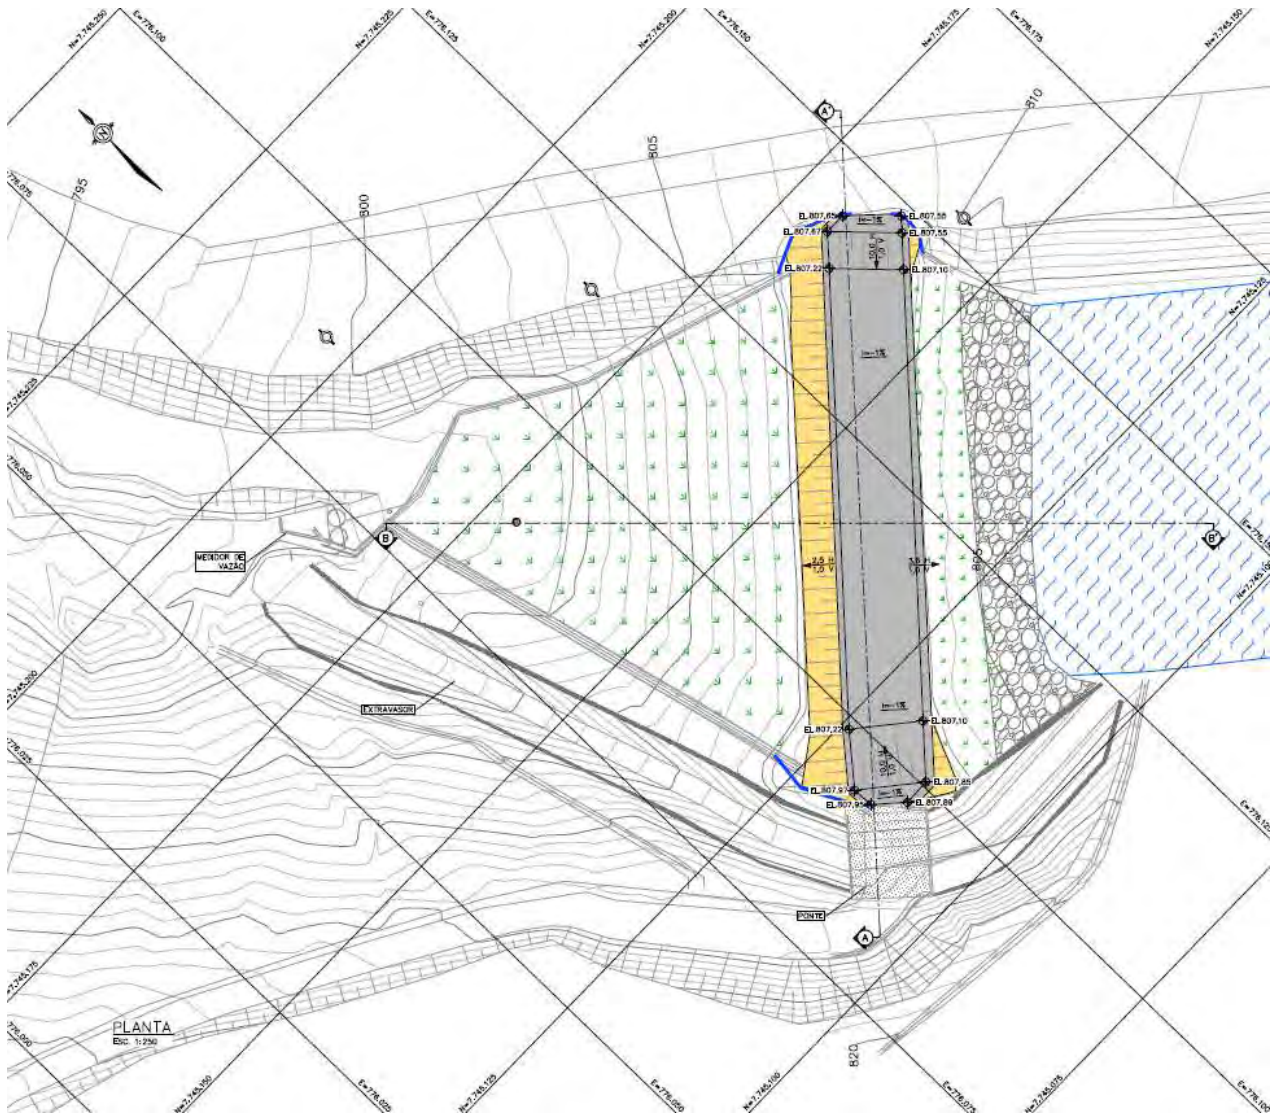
Planta do maciço da Barragem EBII (Planta fornecida pela Samarco).
